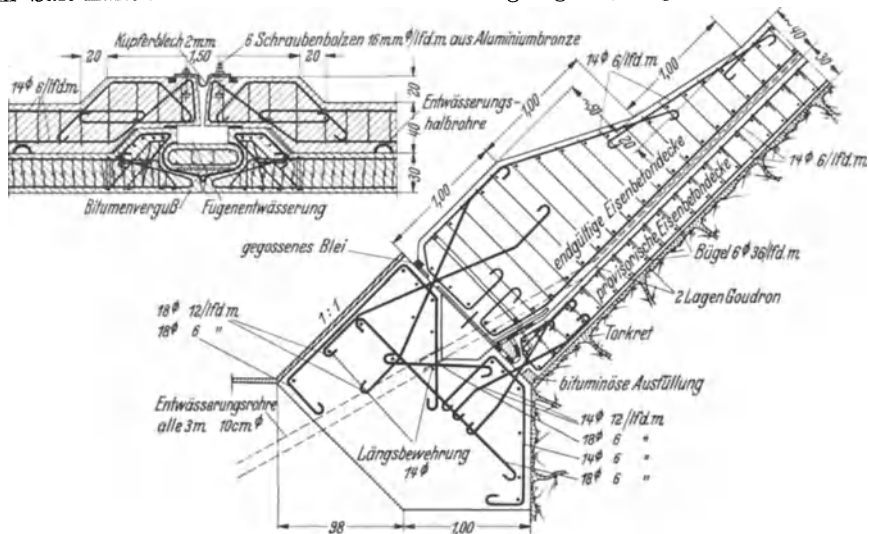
Bakhada-Staudamm. Eisenbetondichtungsdecken.
